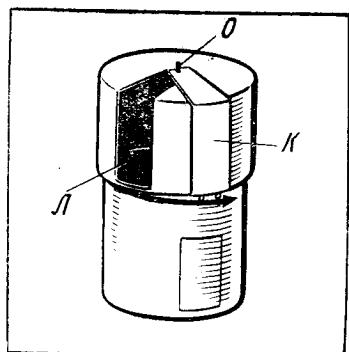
Павильон с вращающимся куполом цилиндрической формы.
